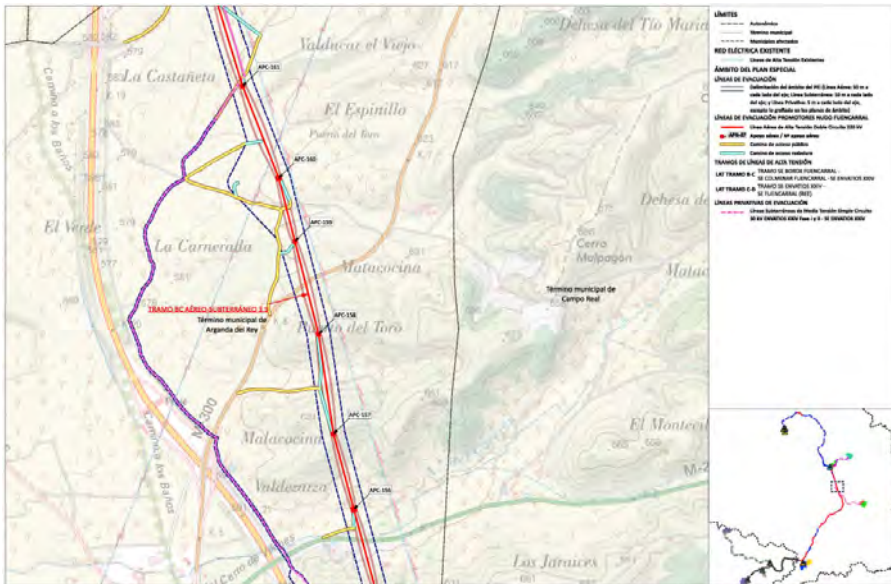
Plano de Ordenación O2.3.13. Planta por tramos. LASAT Promotores Nudo Fuencarral Tramo B-C
